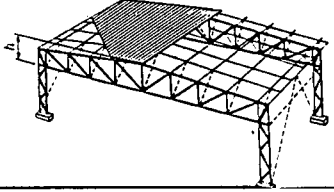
b Trapez kirişin iki parça haline getirilmesi
